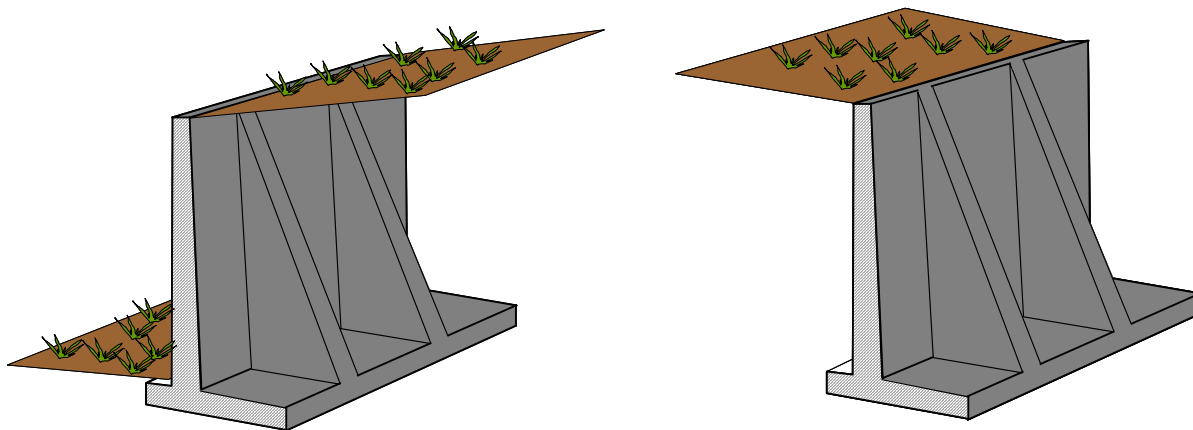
Muri a mensola con contrafforte: a sinistra contrafforti posizionati nella parzione interna del muro; a destra contrafforti posizionati nella faccia a vista del muro -
